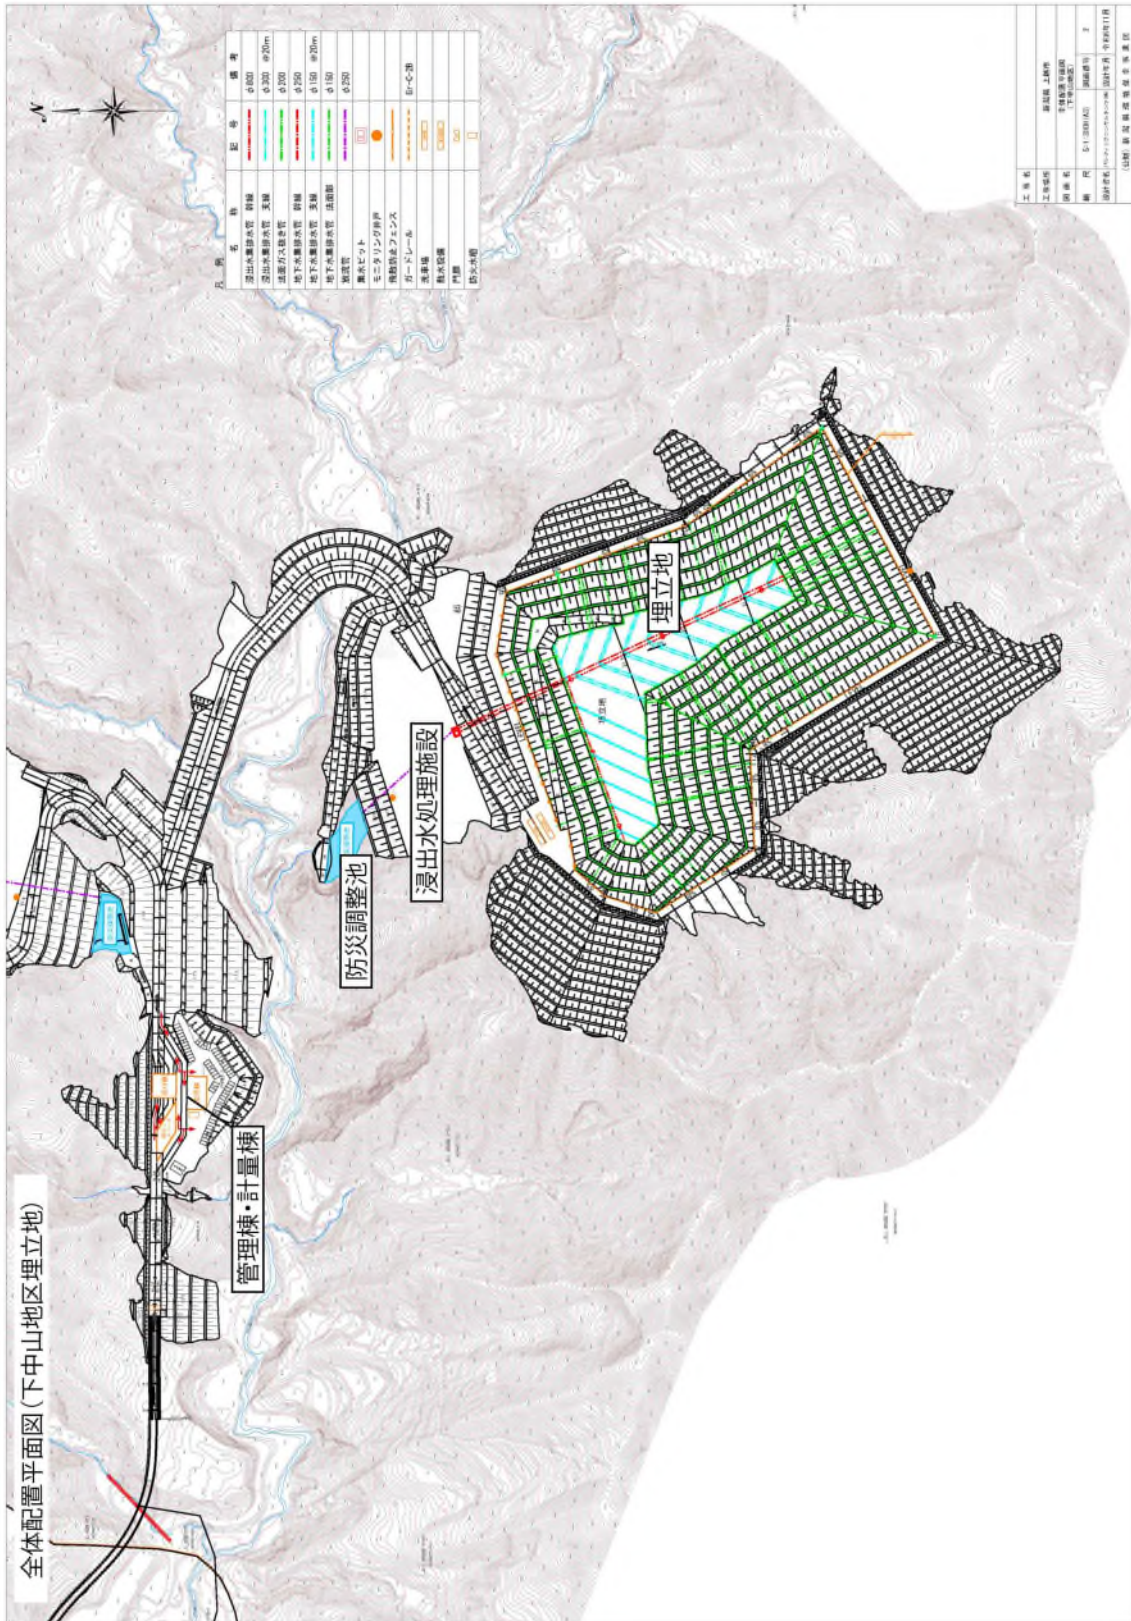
(2) 全体配置平面图 (下中山地区埋立地)
